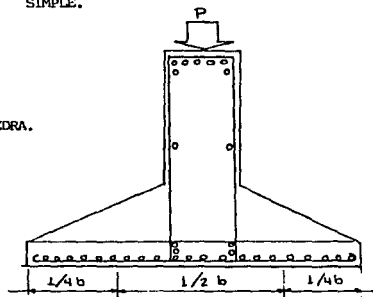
CIMENTACION DE CONCRETO ARMADO.
